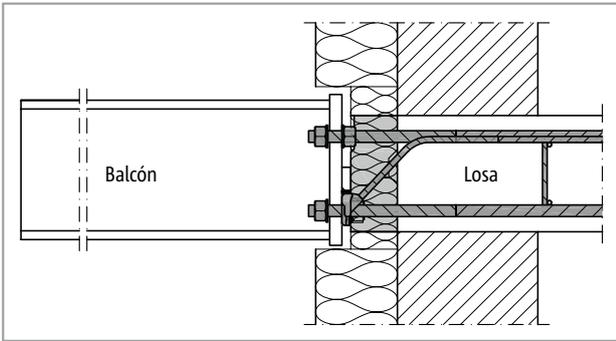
Schöck Isokorb® T tipo SK: Conexión a la losa de hormigón armado; elemento aislante dentro del aislamiento externo
